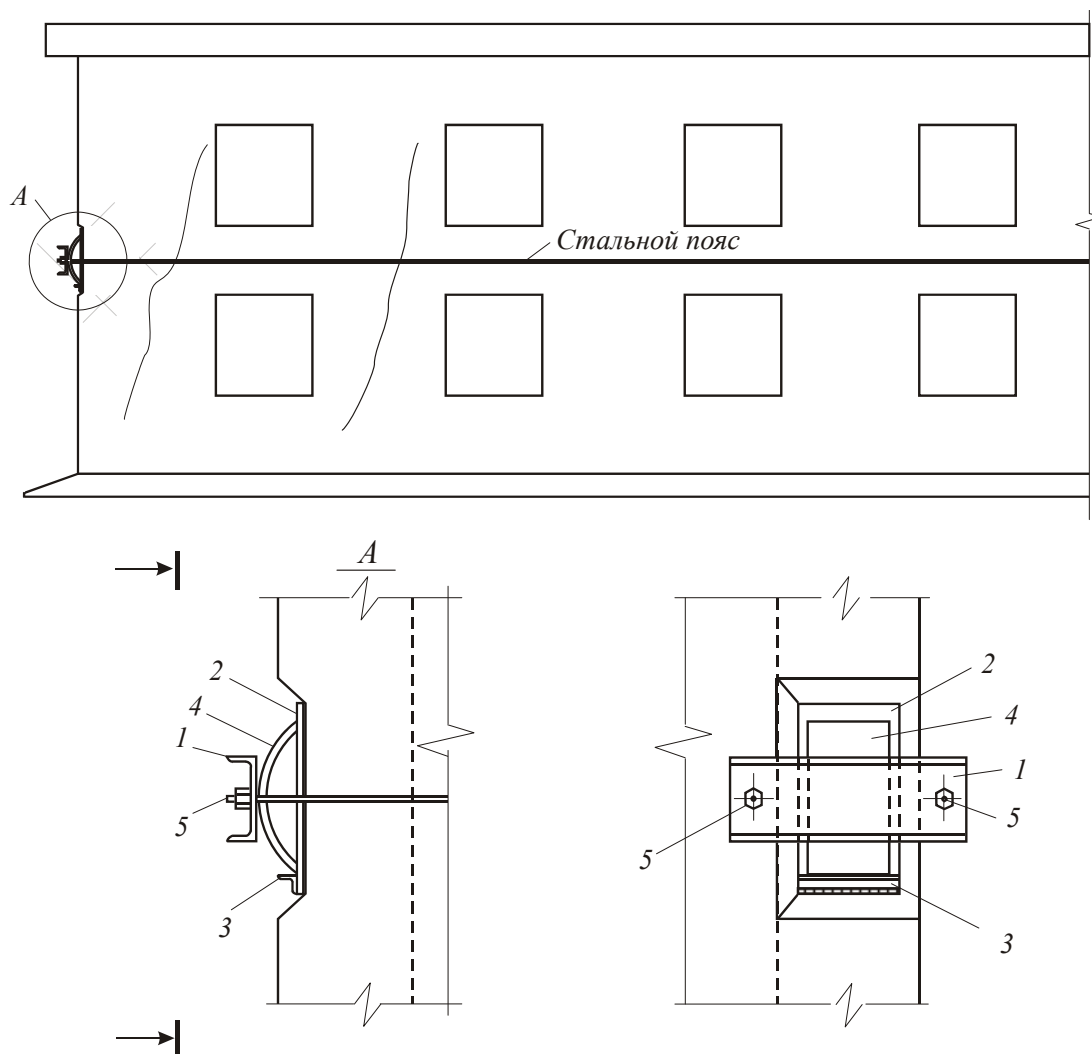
Усиление кирпичной стены поясом со стабилизирующим устройством:
